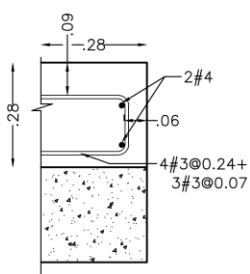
Detalle de Viga Superior (FS65 y FS66)
